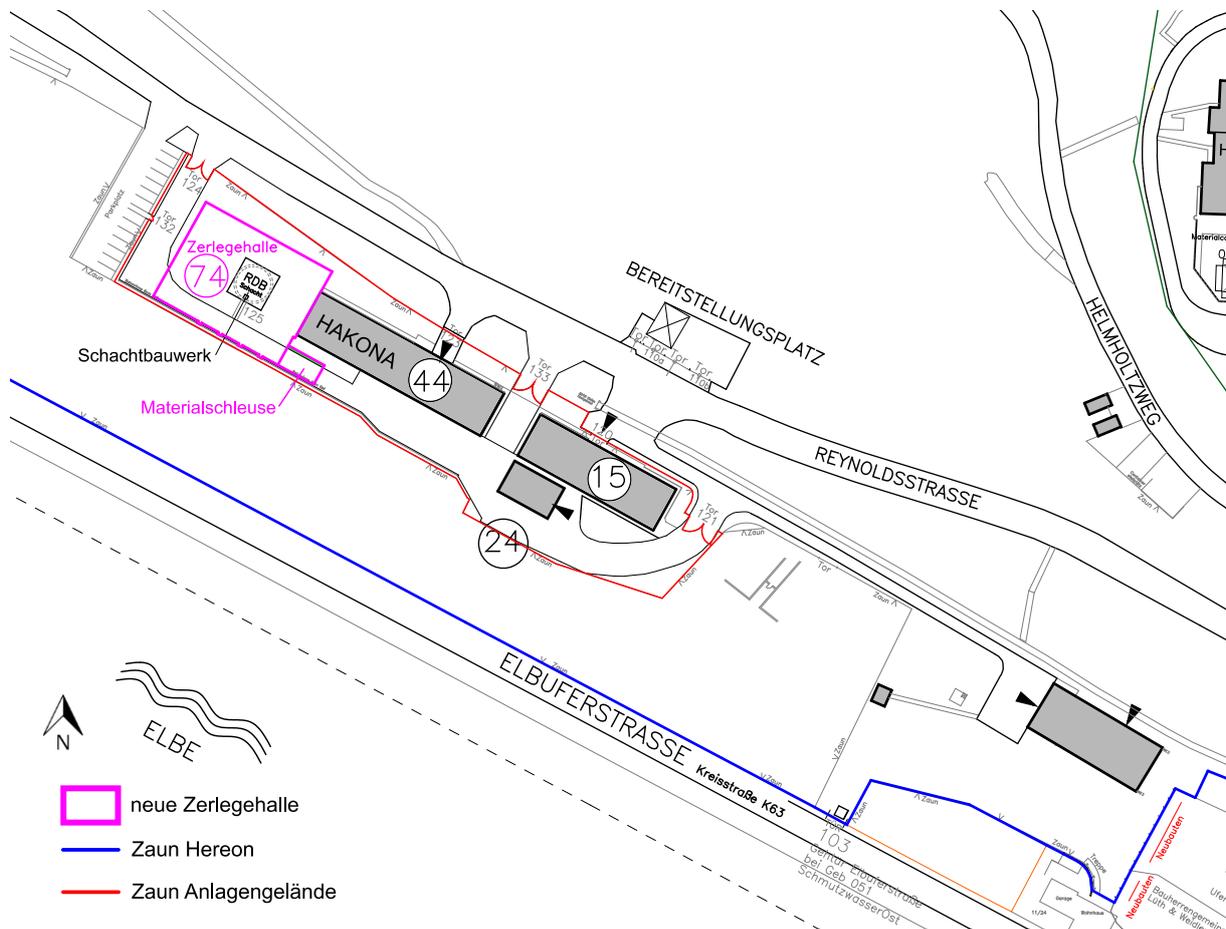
Lage des Schachtbauwerks mit dem RDB-OH und der darüber zu errichtenden Zerlegehalle
